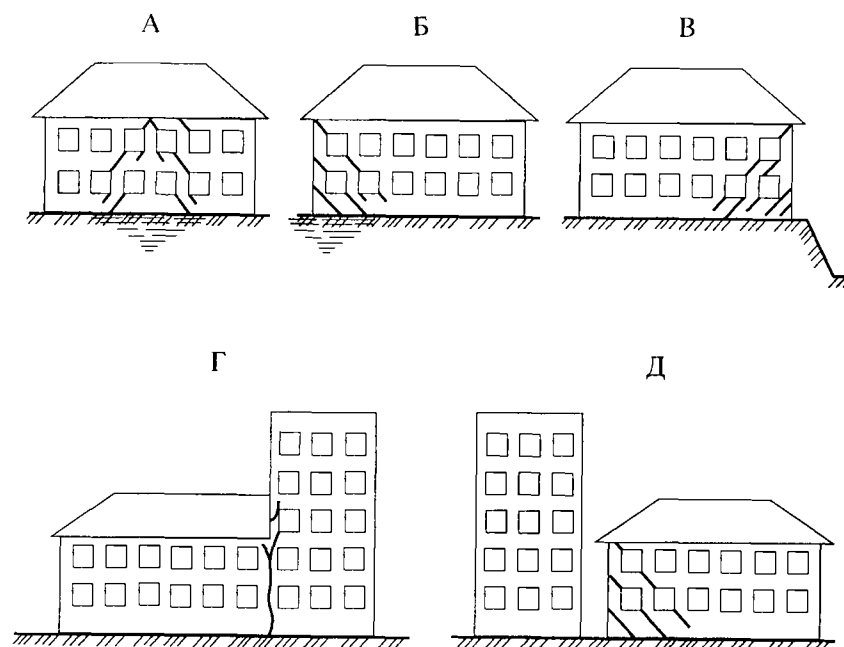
Причины образования трещин в несущих стенах из-за неудовлетворительного состояния основания и фундаментов
